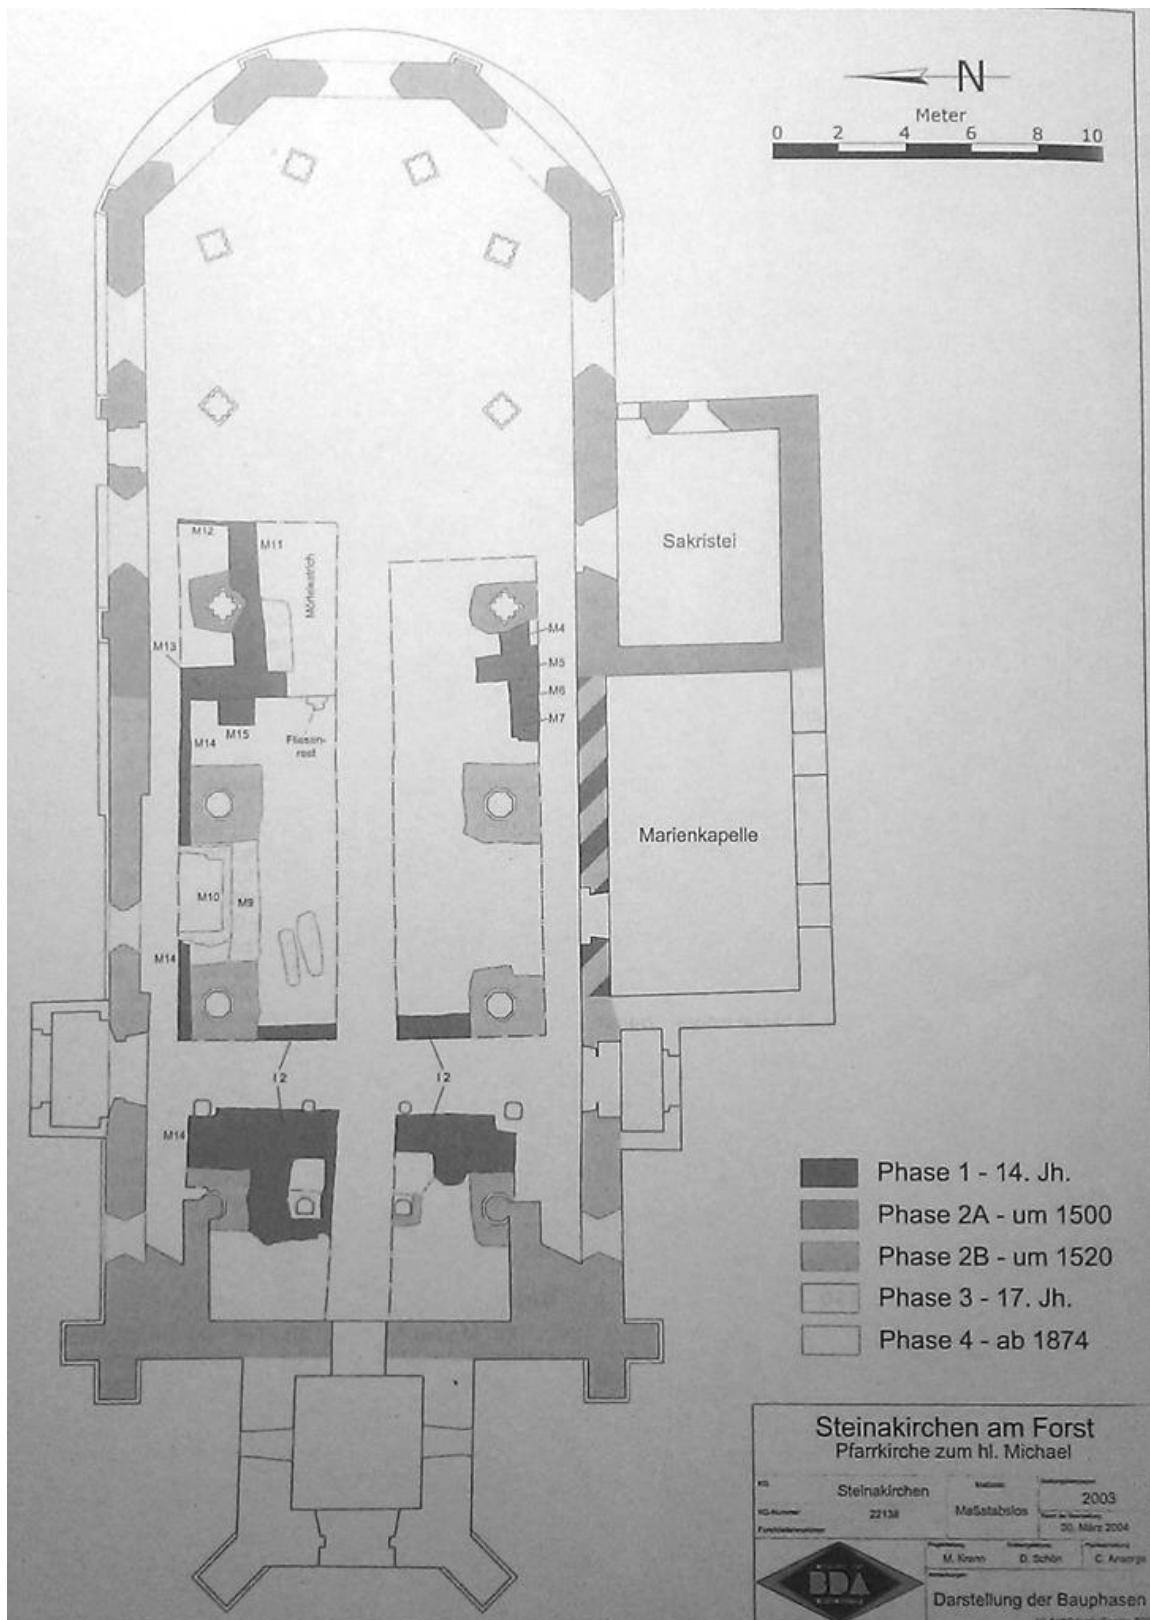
Pfarrkirche Steinakirchen, Befundplan
